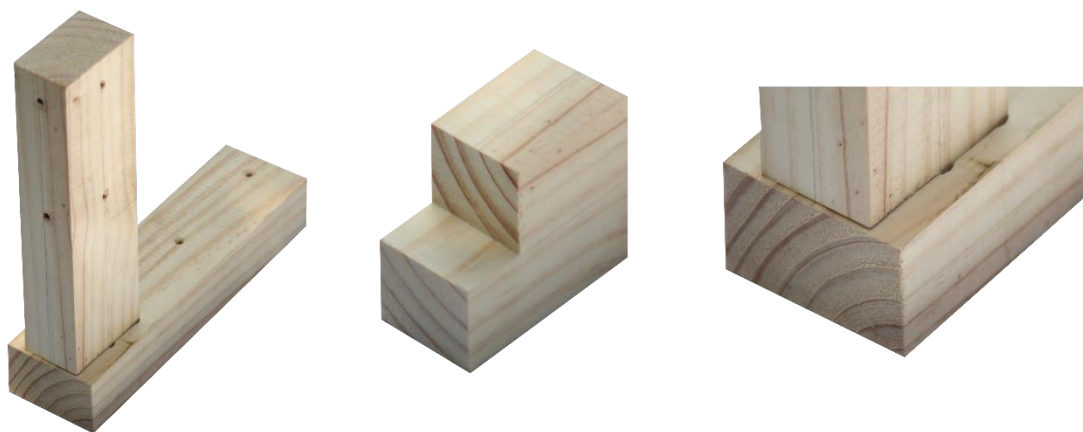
Ensamble caja y espiga unilateral | Detalle espiga 5 | Detalle ensamblaje.
